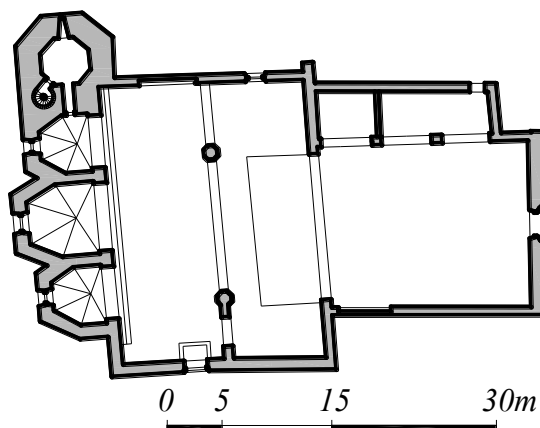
Chiesa di S. Pietro di Coppito: Pianta
